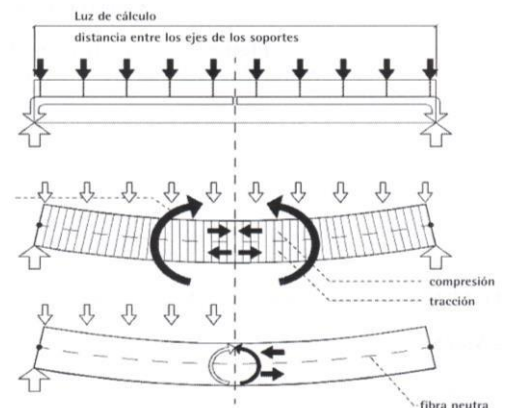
Flexión en viga simplemente apoyada con carga distribuida.
